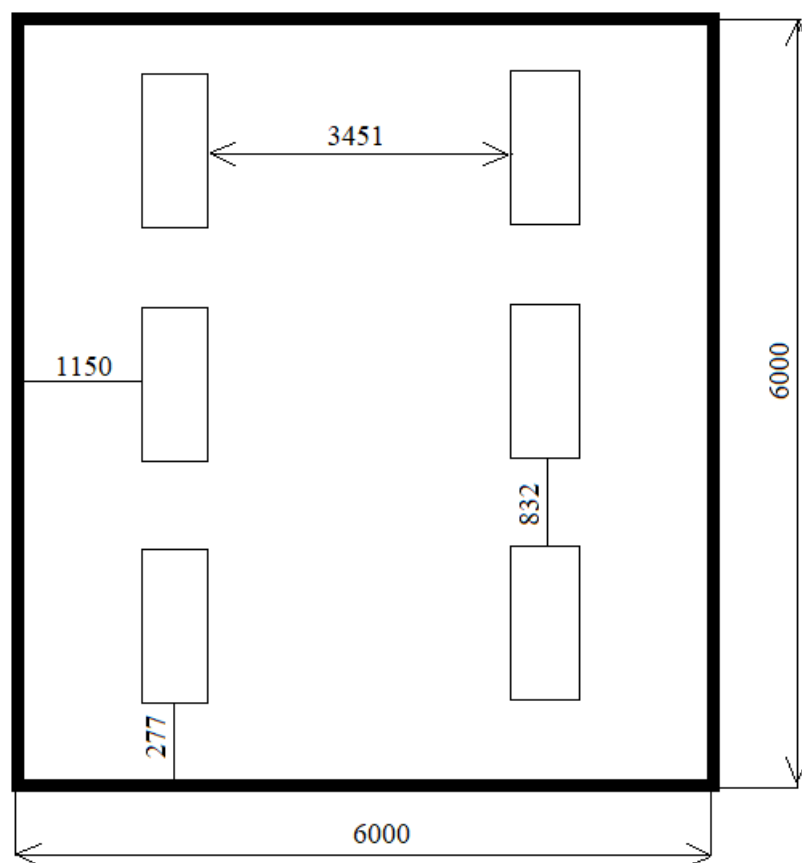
План помещения и размещения светильников со светодиодными лентами
